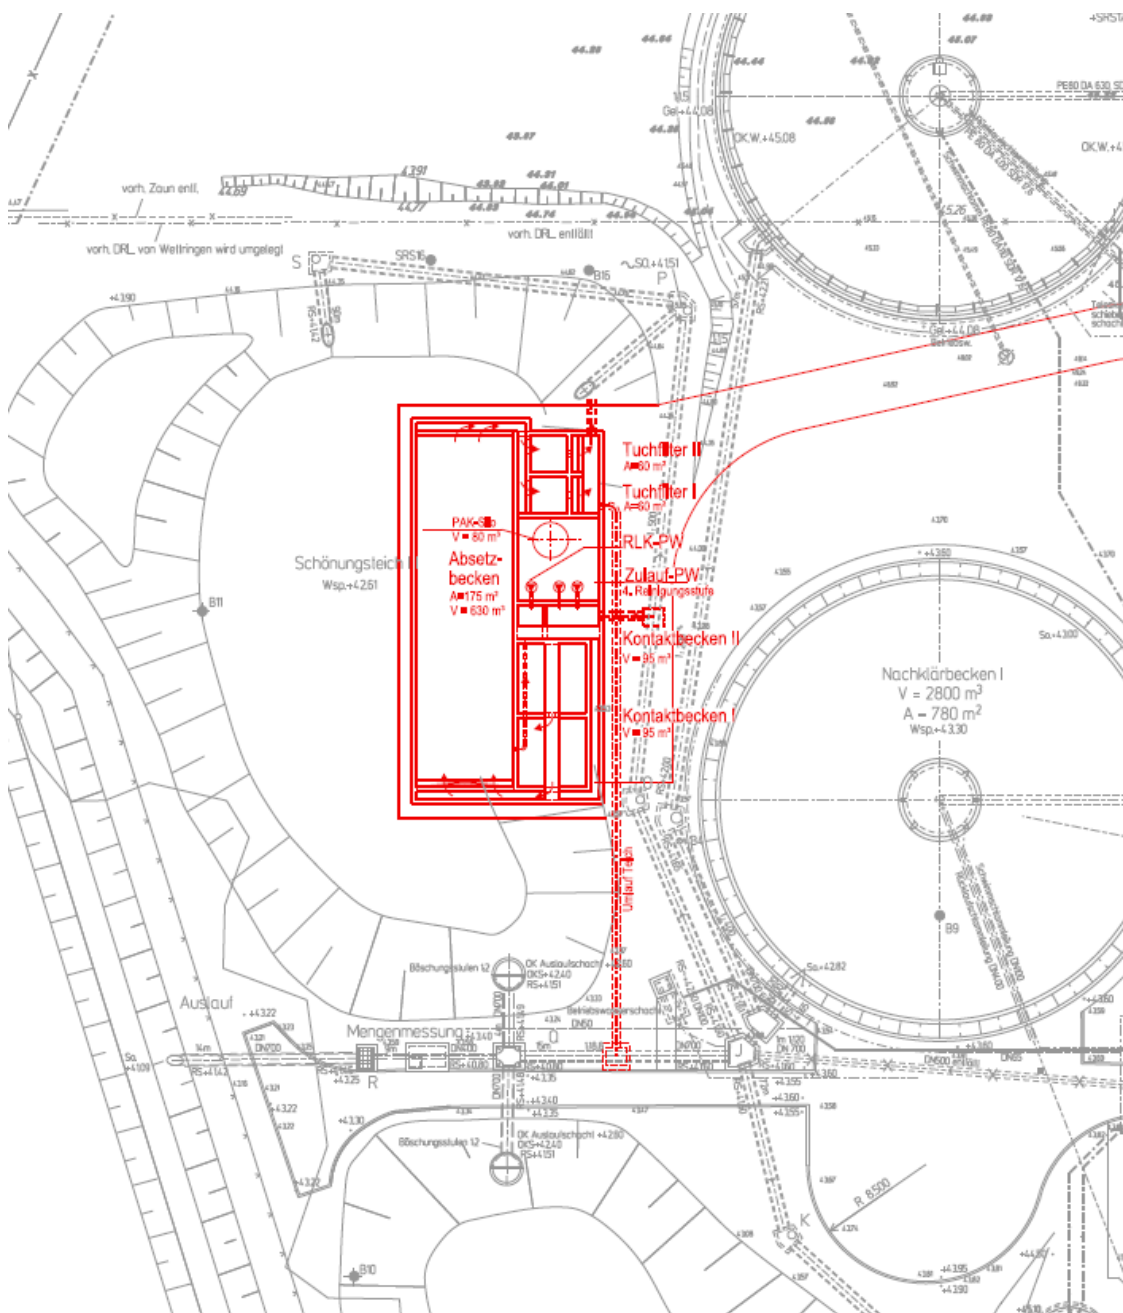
Lageplanausschnitt Variante 1: PAK-Dosierung mit Rücklaufkohle
